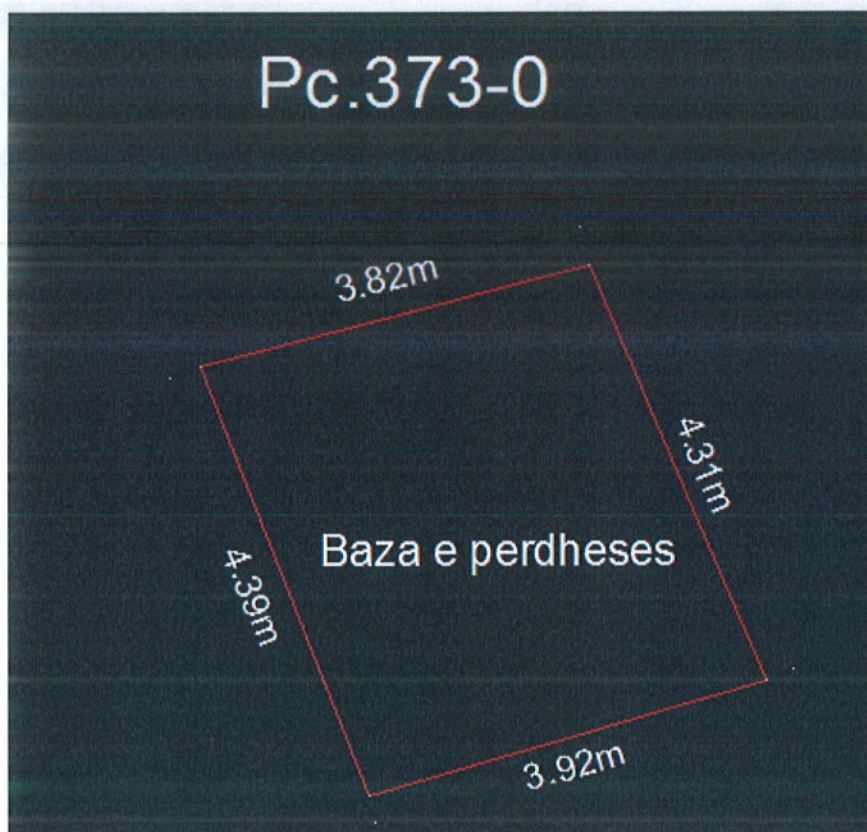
Dimensionet e përdhësës së objektit afarist marr nga Formularit i Inqizimeve të Strukturës
